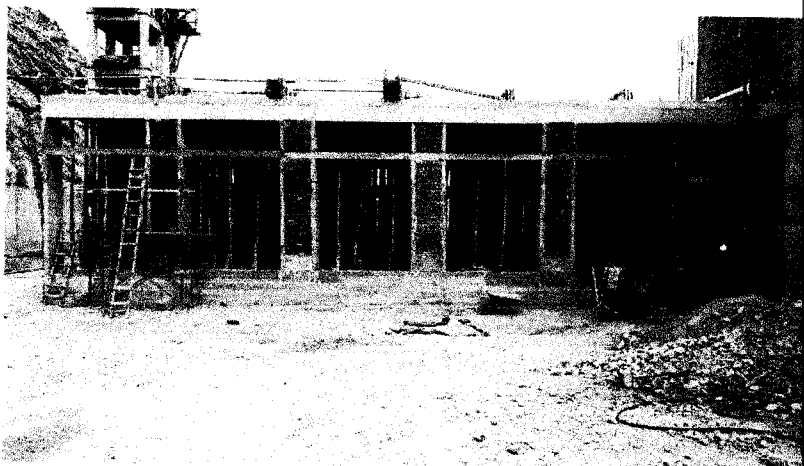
Encofrado de muros de concreto armado y columnas en tanque elevado.
